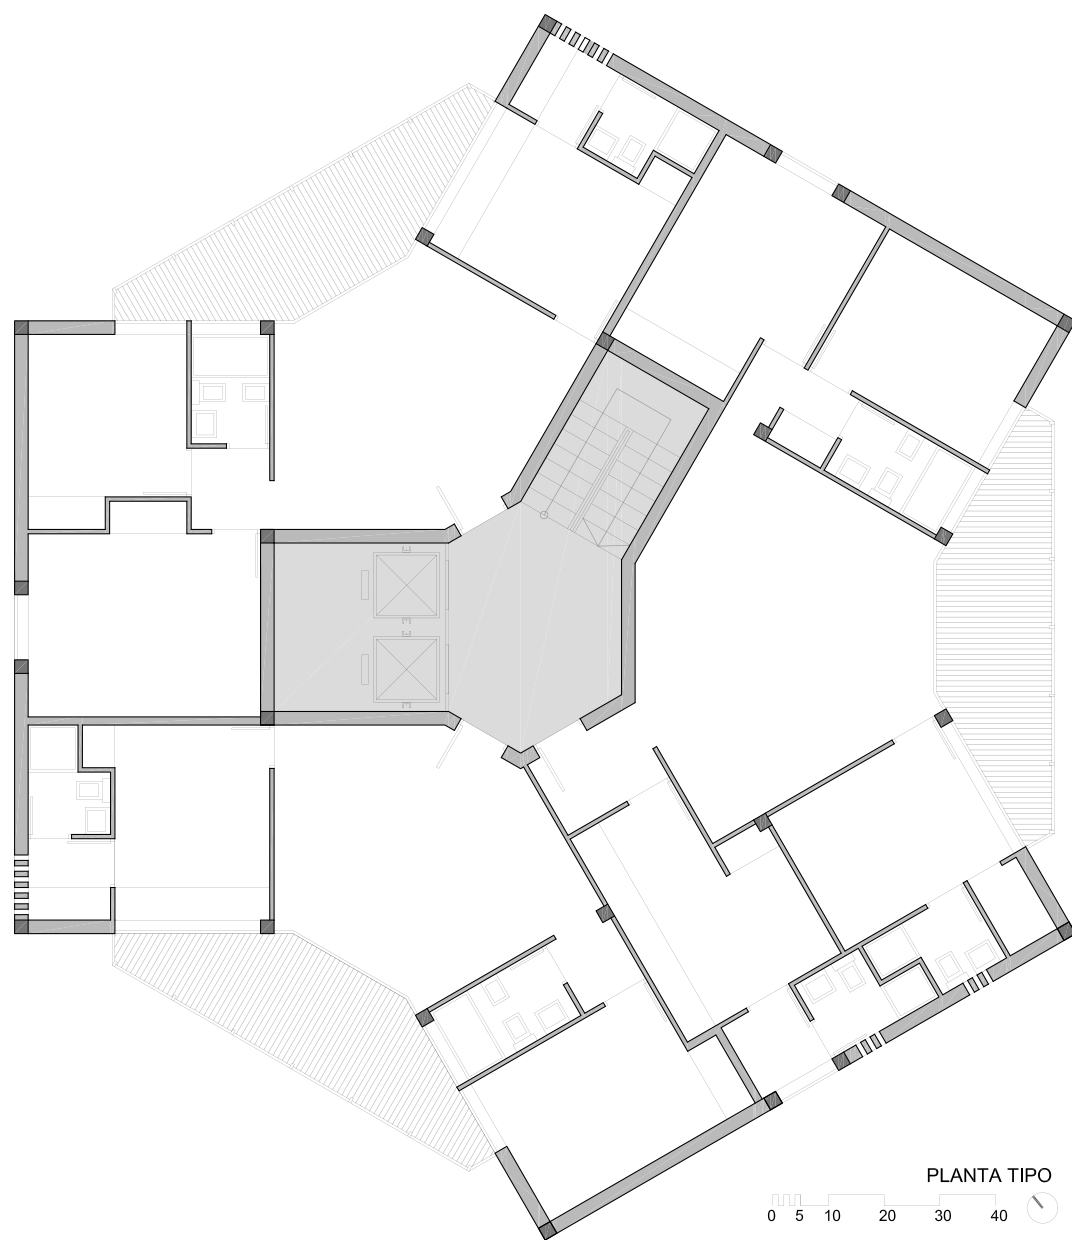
Planta tipo de la Torre Hexagonal. Elaboración propia
